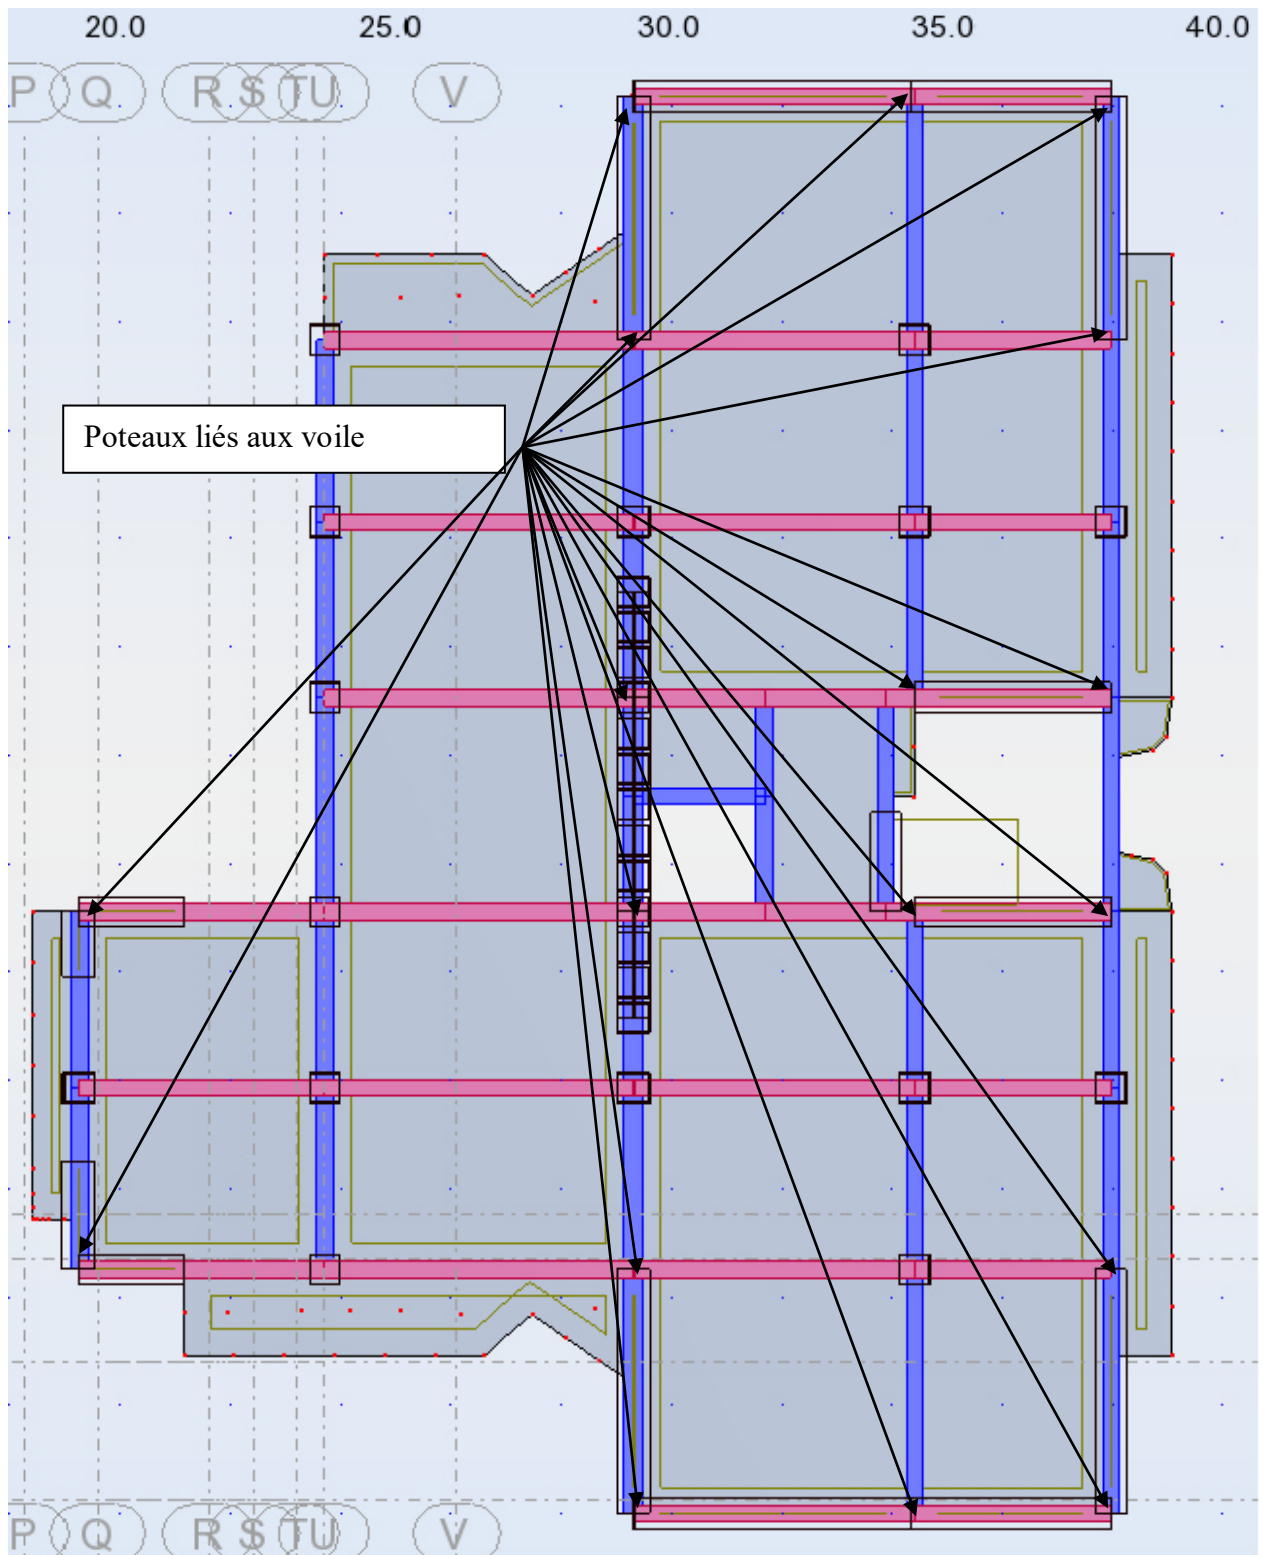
Schéma montrant la disposition des poteaux isolés et des poteaux solidaires aux voiles
